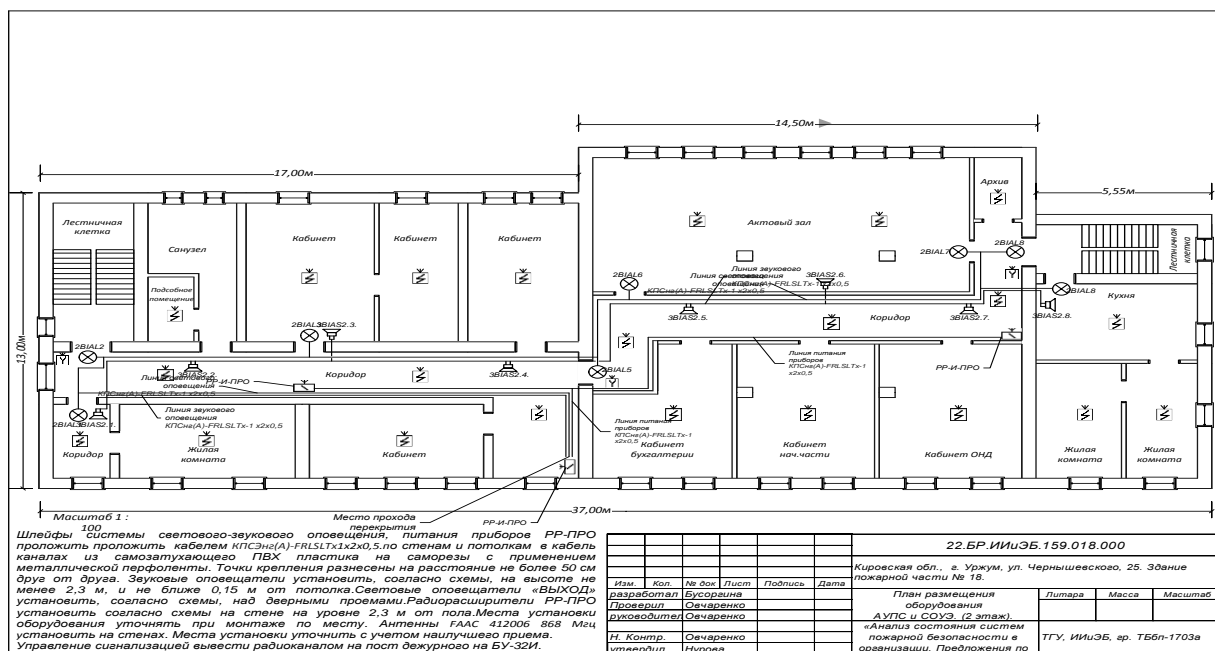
План размещения оборудования АУПС 2 этаж
